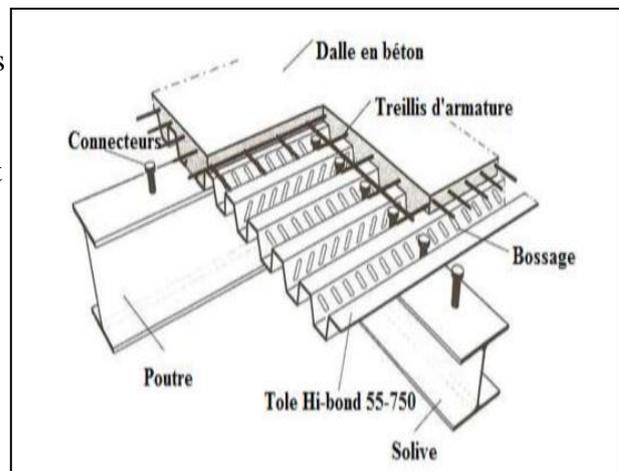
Détail Plancher collaborant Source : <http://btscm.fr/dicocm/P/Technoplancher>
